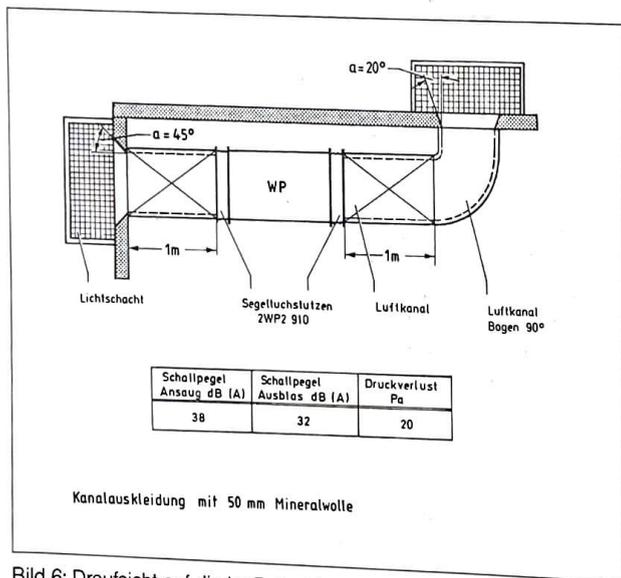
Draufsicht auf die im Beispiel genannte Anlage
